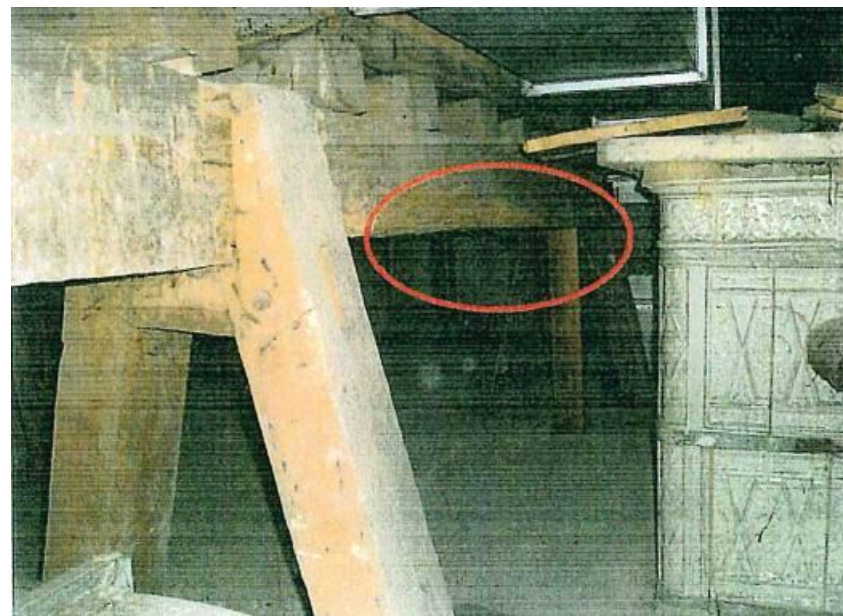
Attaques parasitaires poutres – Extrait rapport Apave
